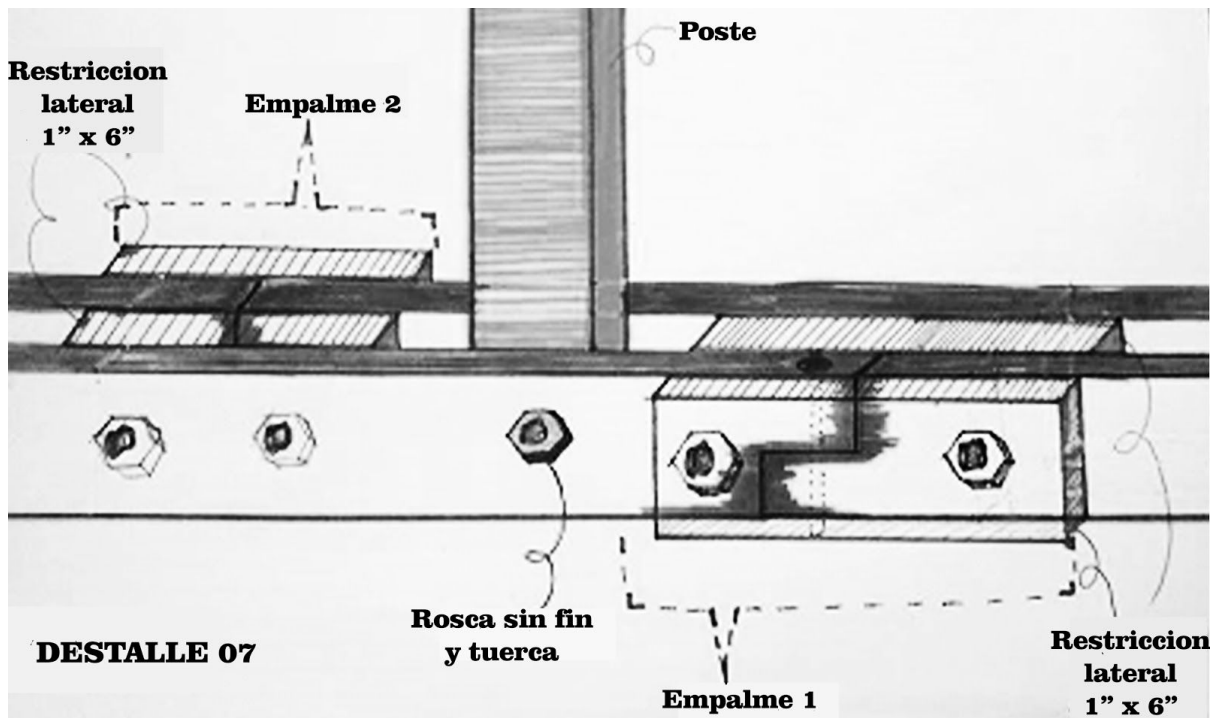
(Elaboración propia, 2019). Detalle de empalme en madera.
